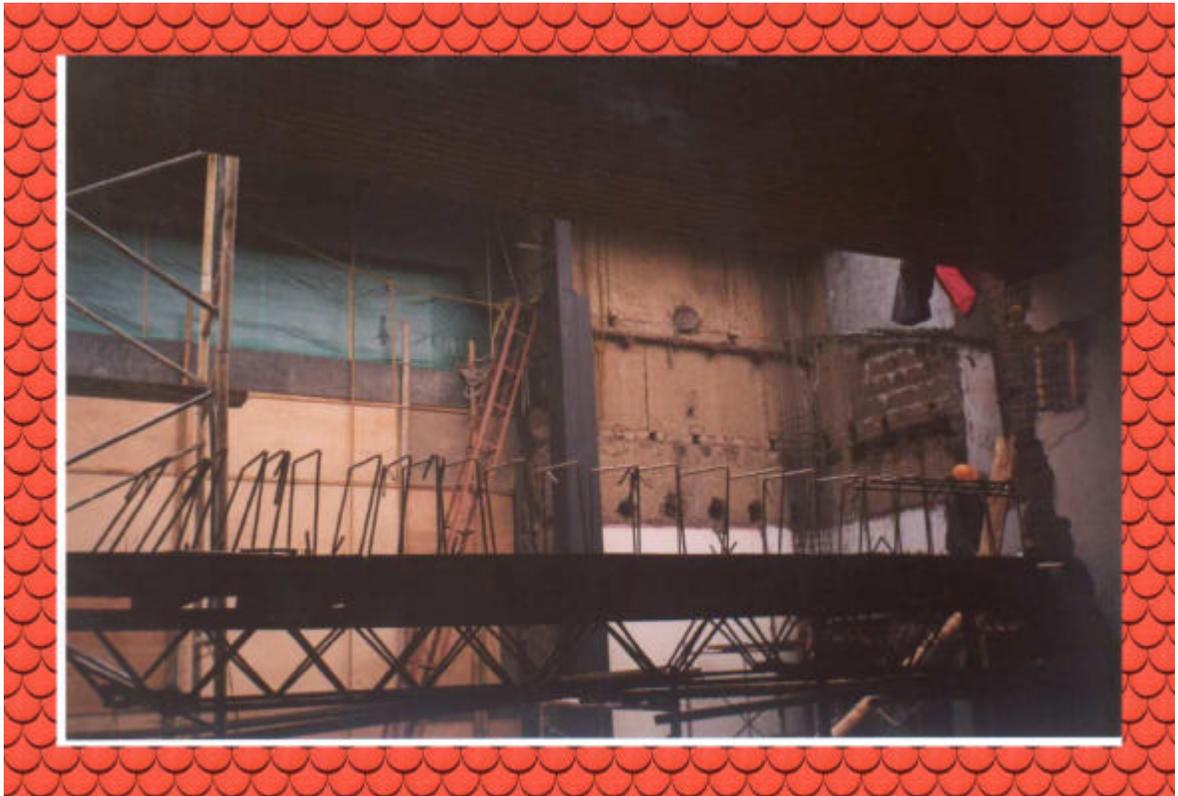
Montaje de dos vigas al nivel 11.06m, donde una de ellas tiene platina doble y es pernada
